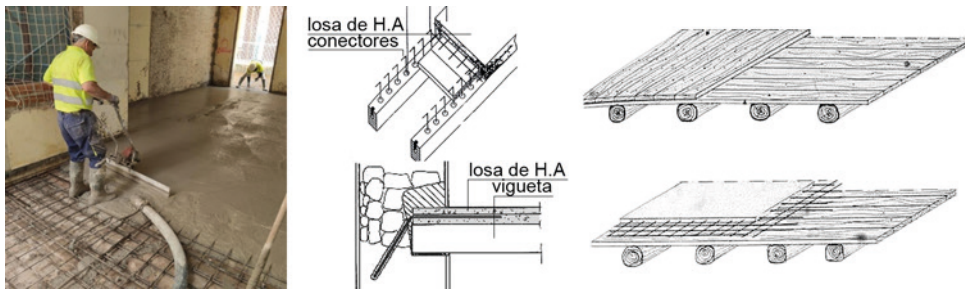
En la foto y gráfico derecho inferior, superposición de chapas de hormigón armado conectadas a las viguetas de madera en tramos de forjado de insuficiente resistencia. En los gráficos del centro, ejemplo de conexión de la chapa a los muros laterales y a las viguetas. En el gráfico superior derecho, esquema de superposición de enrastrelado transversal de madera para dotar de mayor rigidez al forjado.
